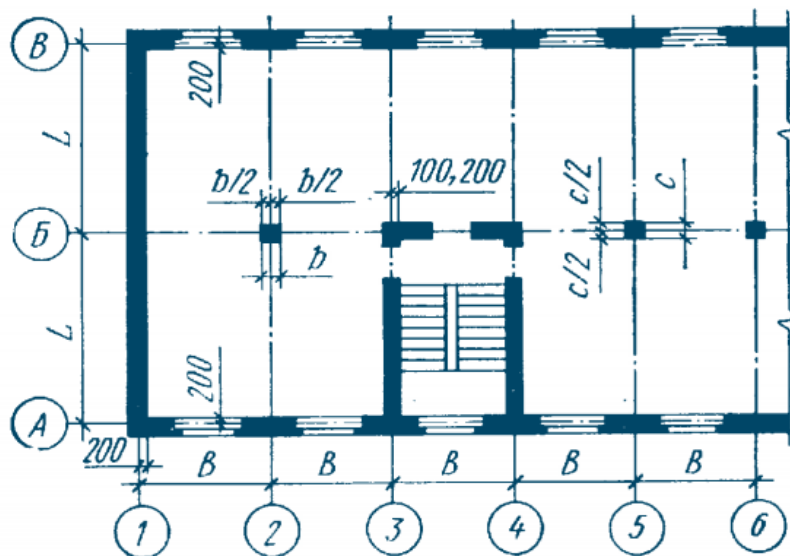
Схема розташування координаційних осей на плані будівлі: В – крок, L - прогін
